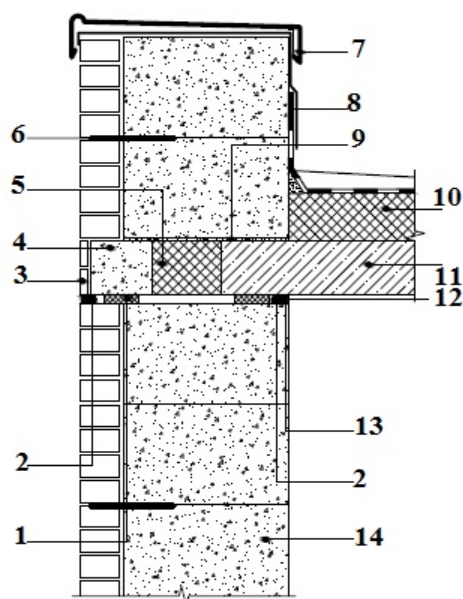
Устройство парапета здания с совмещенной кровлей (каркасно-монолитное строительство): 1 — минераловатная плита; 2 — пороизол; 3 — керамическая плитка на цементном растворе; 4 — доборный блок; 5 — вкладыш из эффективного утеплителя; 6 — металлическая связь; 7 — защитный фартук из оцинкованного стального листа; 8 — гидроизоляция; 9 — выравнивающий раствор; 10 — конструкция кровли (по проекту); 11 — монолитное железобетонное перекрытие; 12 — затирка цементно-песчаным раствором; 13 — нетвердеющая герметизирующая мастика; 14 — блоки YTONG
